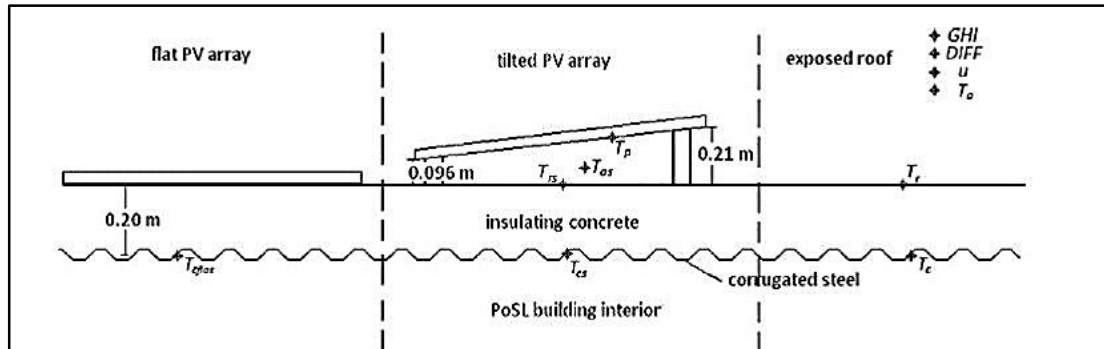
Cubierta del edificio compuesta por planchas metálicas y concreto. Fuente: Effects of Solar Photovoltaic Panels on Roof Heat Transfer. A. Dominguez, J. Kleissl, & M. Samady, Univ of California, San Diego J. C. Luvall, NASA, Marshall Space Flight Center.
